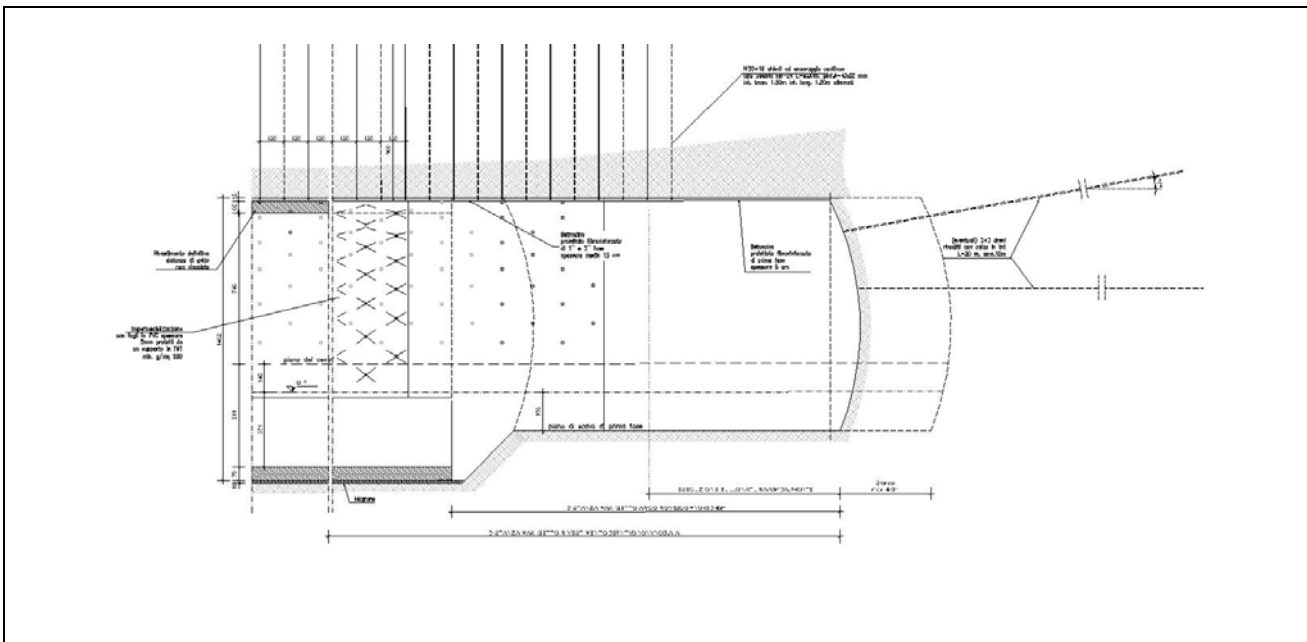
Sezione di scavo tipo GD-PS-A1 – PIAZZOLA DI SOSTA - Sezione longitudinale
